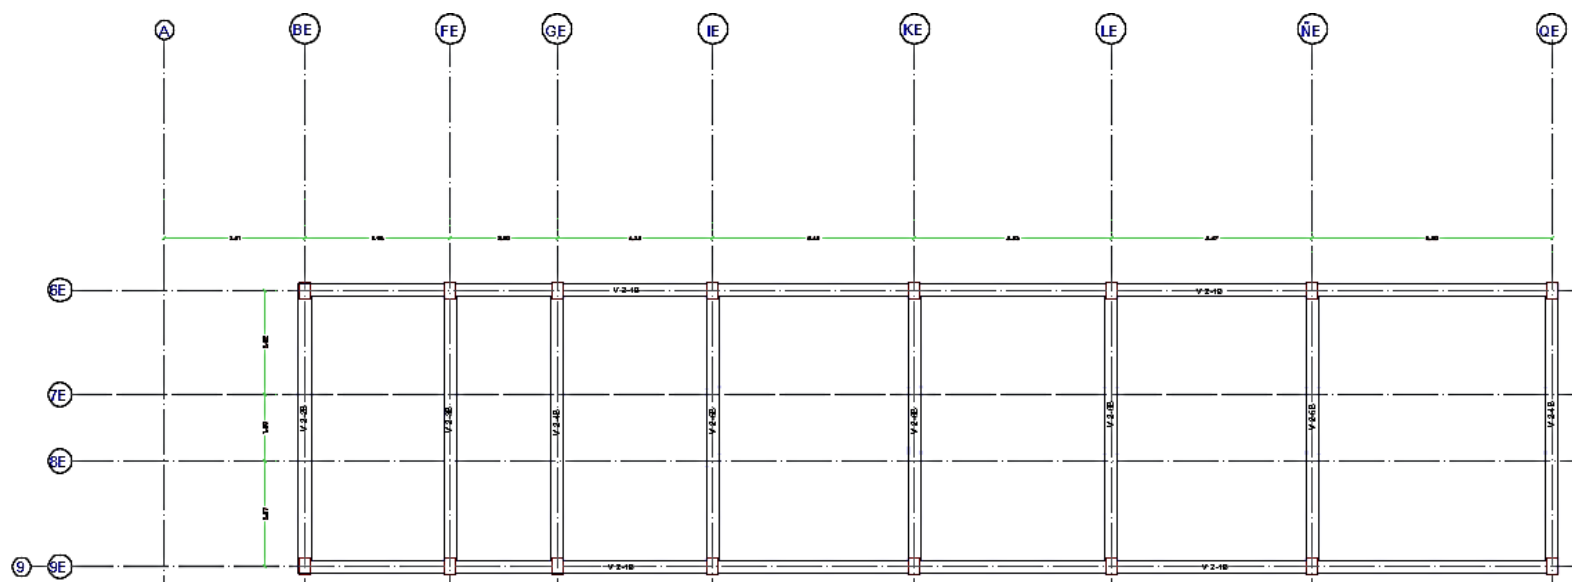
Planta estructural zona B, nivel 6.90 m. Fuente: Autor.
